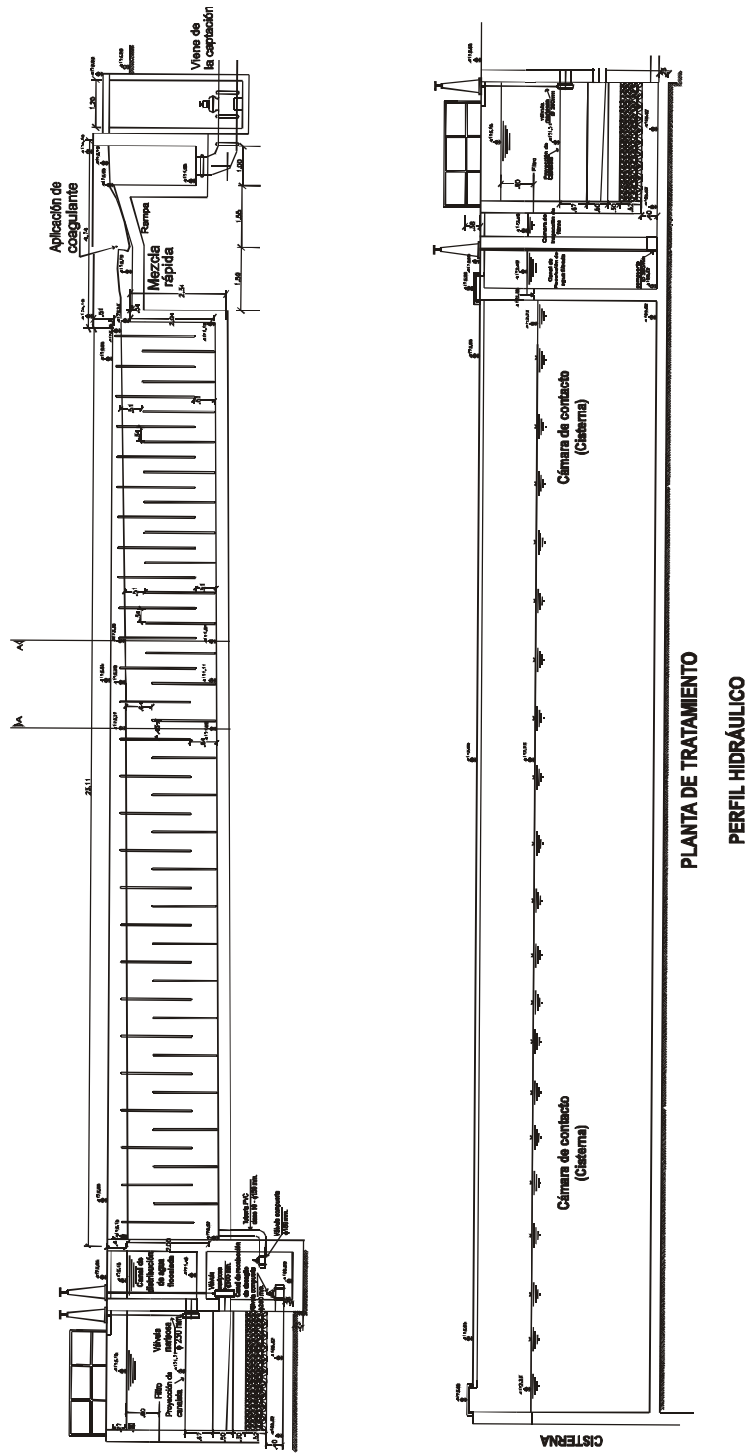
(b). Perfil hidráulico de la planta de filtración directa
